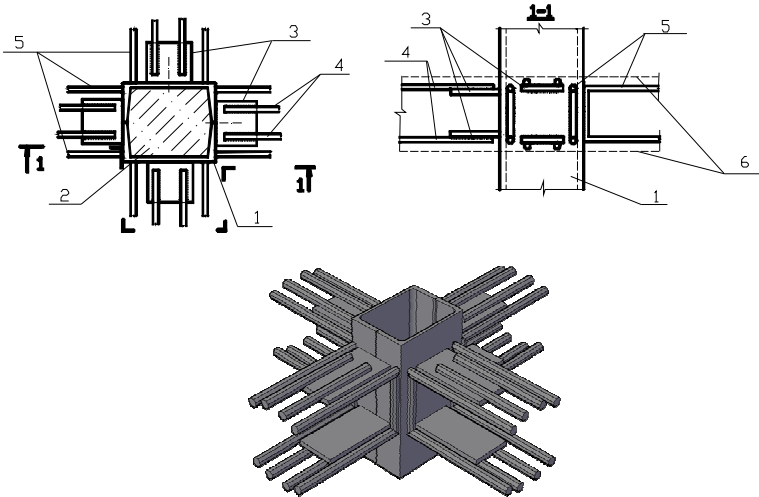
Безкапітільний вузол з'єднання монолітного безбалочного перекриття з колонами зі швелерів:
